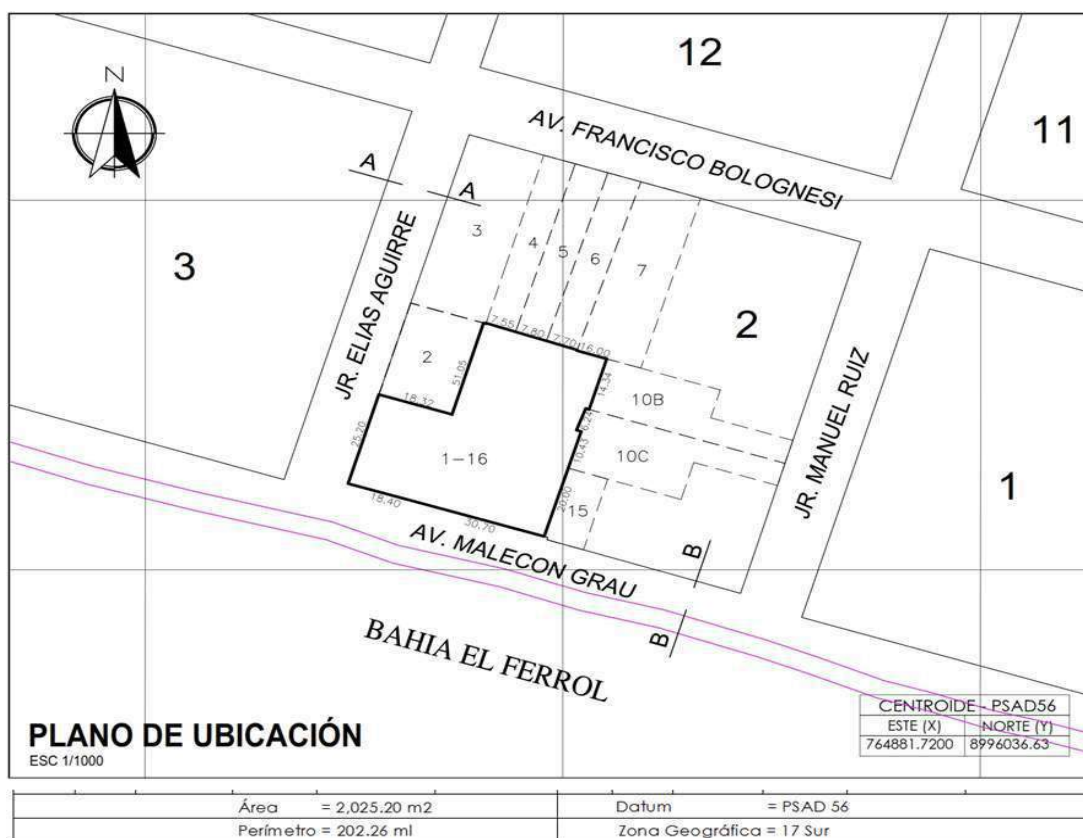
Fuente: Catastro de Chimbote 2003 Plano de ubicación del terreno y Perfil Urbano Avenida Malecón Grau y Jirón Elías Aguirre. -2004 (MPS, 2021) y elaboración propia.
